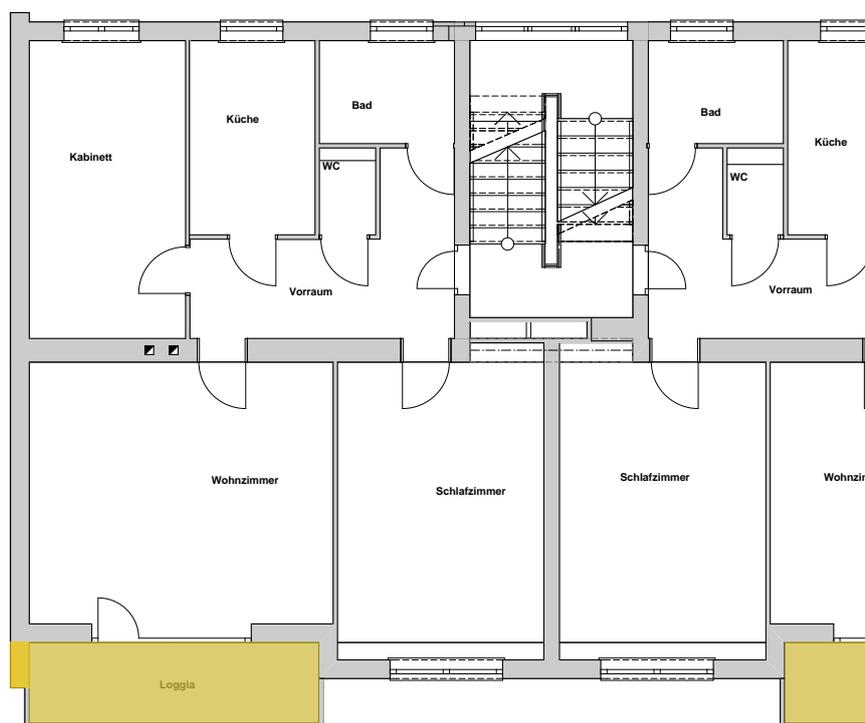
Grundriss mit farbigen Mauerflanken und Loggien [Quelle: eigene Abbildung]
